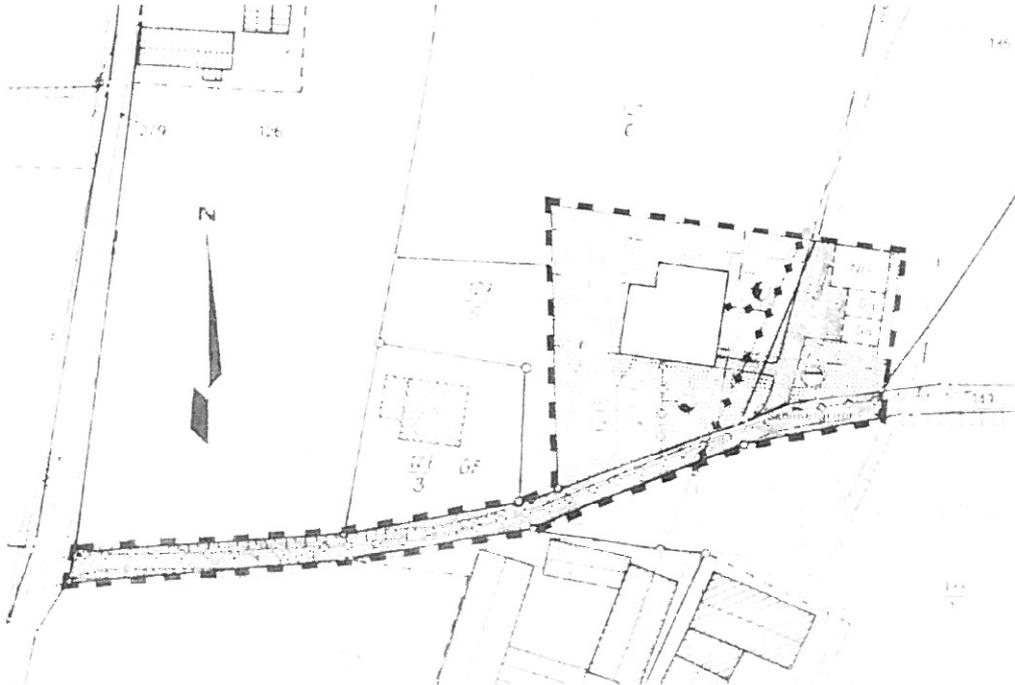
Ausschnitt Planzeichnung VE-Plan 15 „Eigenheim Mertens – Jessen Unterberge“
